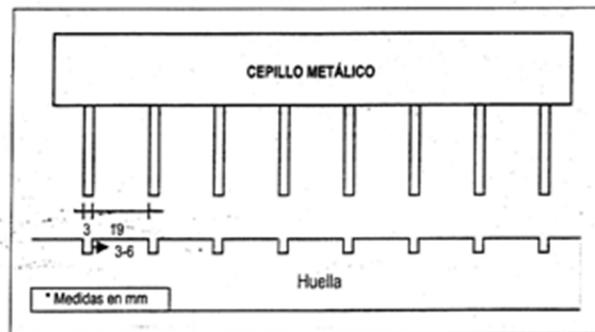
Dimensiones del cepillo metálico para el macro texturizado de las losas y reparaciones en pavimento rígido
